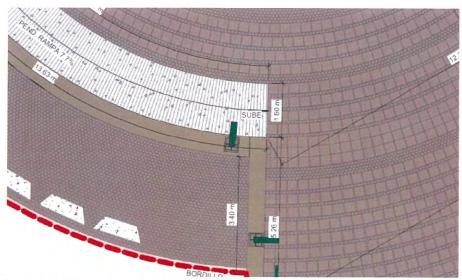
Despiece en planta de desembarco Rosario Castellanos, se observan las piezas precoladas cuadradas (30x30x6 cm) y las piezas cilíndricas (10 cm de diámetro con 6 cm de espesor) en planta.
